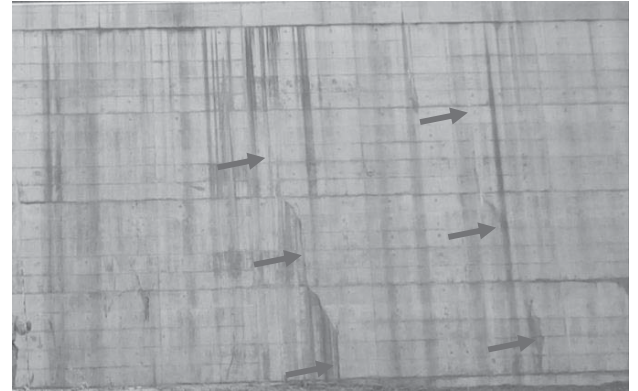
温度応力ひび割れの可能性があるひび割れ
